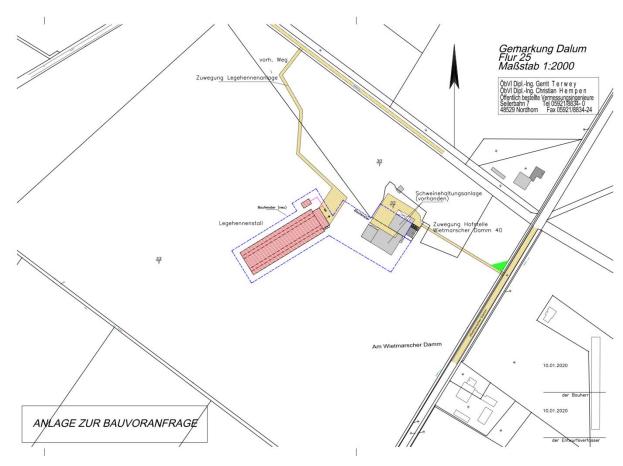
Lageplan der geplanten Anlage (Vorentwurf)
